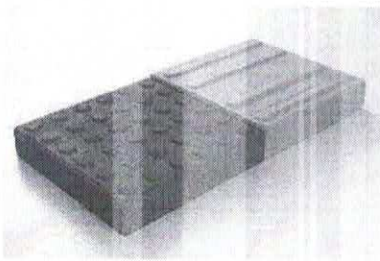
Piso intertravado de concreto, dimensão 20x20cm, modelo tátil guia/alerta
